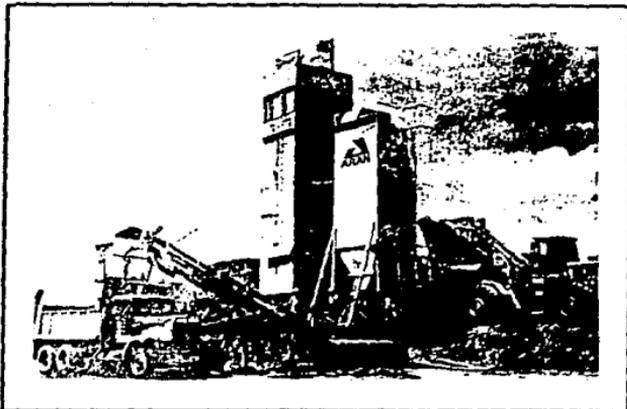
PLANTA DOSIFICADORA DE C. C. R.
